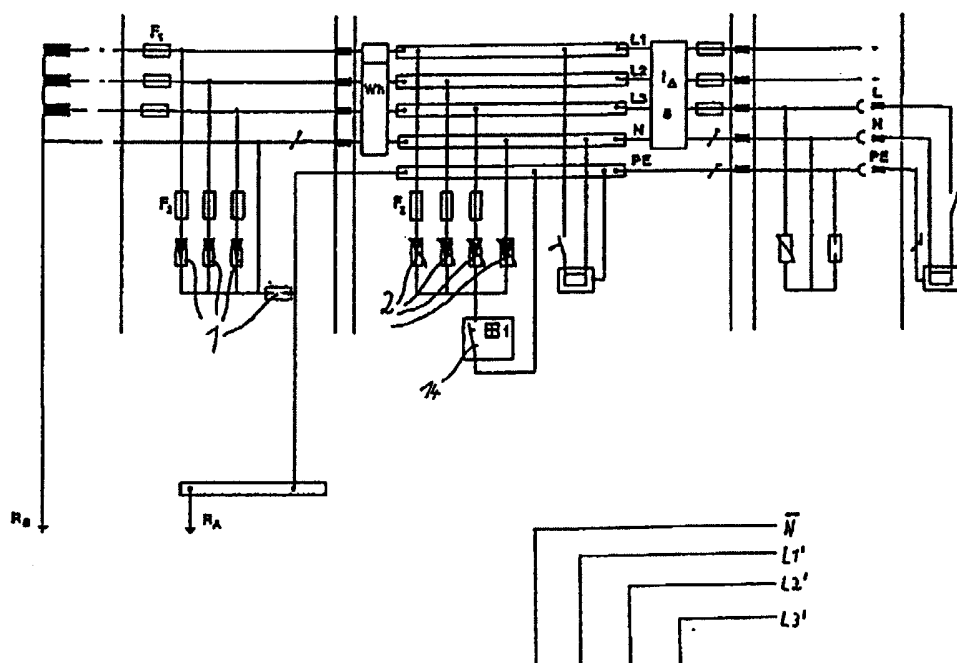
Zapojení přístrojů k ochraně před přepětím v rozvodné soustavě typu TT
